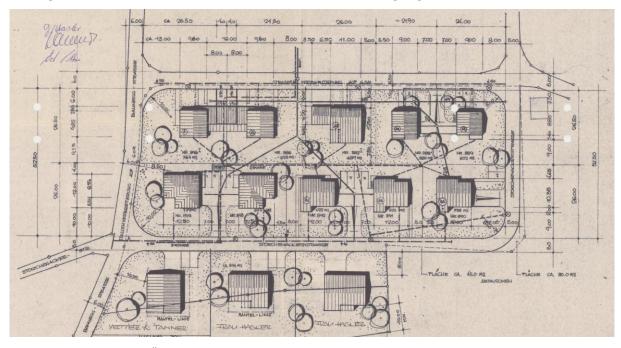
Gestaltungplan Überbauung Storchenacker, 1975
